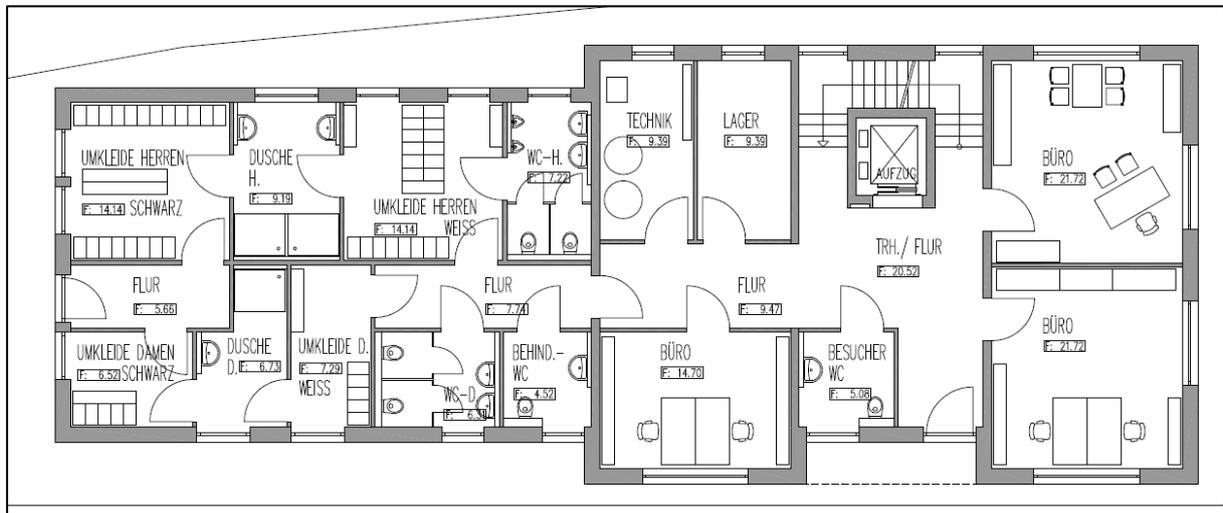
Vorentwurf eines zweigeschossigen Betriebsgebäudes – Erdgeschoss
